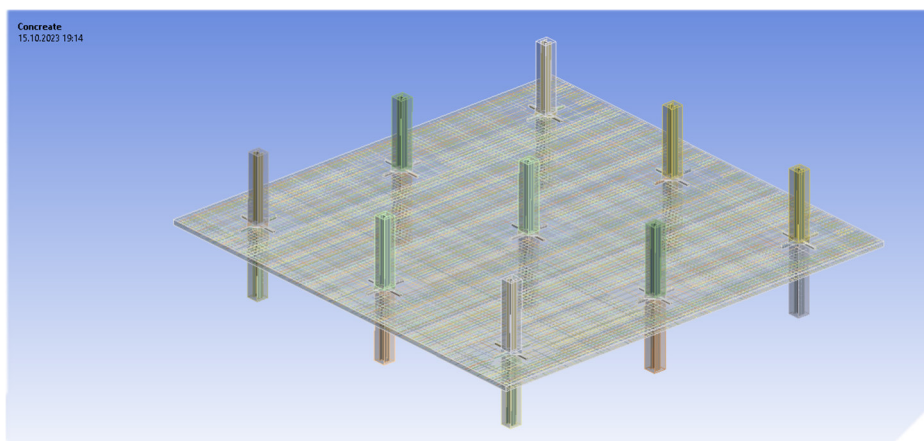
Расчетная схема перекрытия с балочными срезными узлами в расчетной среде Ansys
